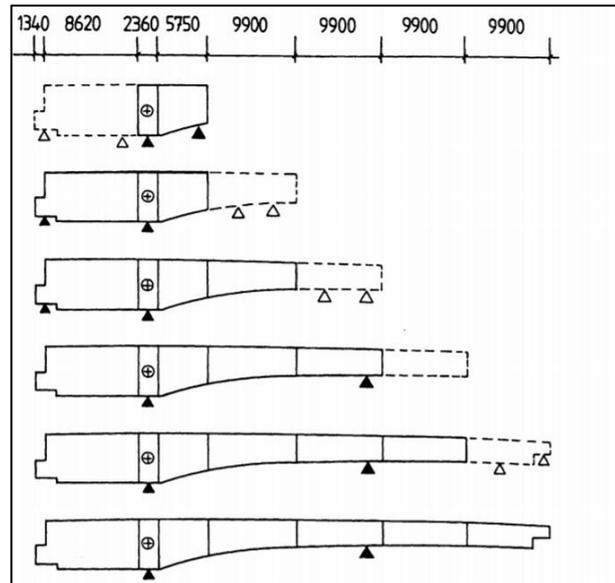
secuencia armado en tierra puente Gálata [3]
